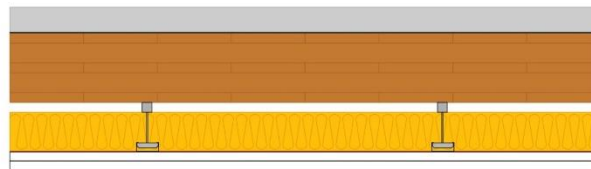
Schéma de principe du plancher des salles SX3 et SX4.
